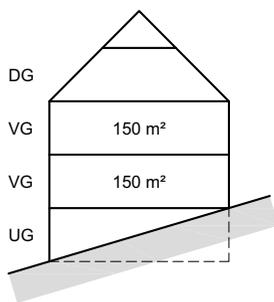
Anrechenbare Grundstücksfläche (§ 259 PBG)
